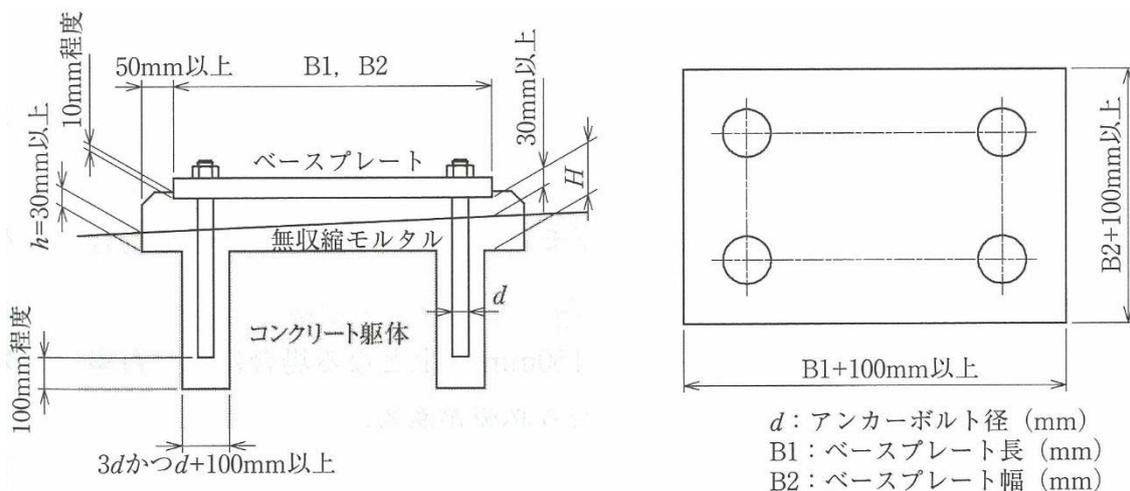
支承下面のモルタル厚及びアンカーボルトの埋込み長
